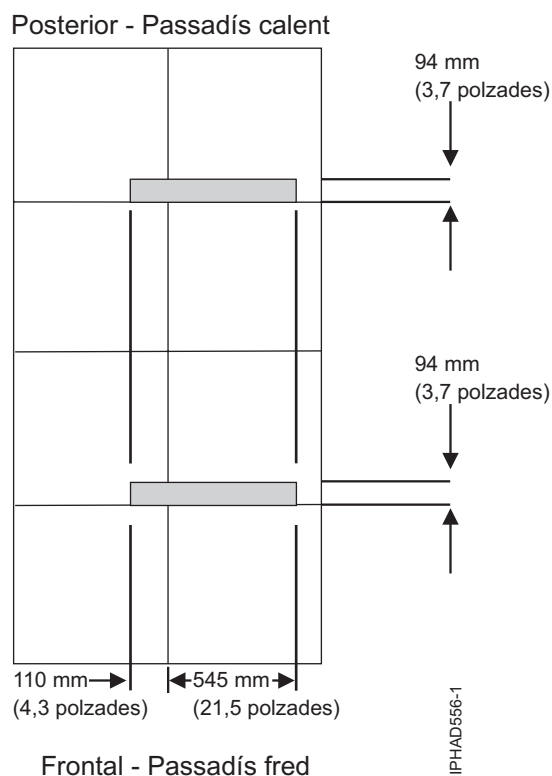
Col·locació de l'obertura de cables en les plaques de 610 mm (24 polzades)
